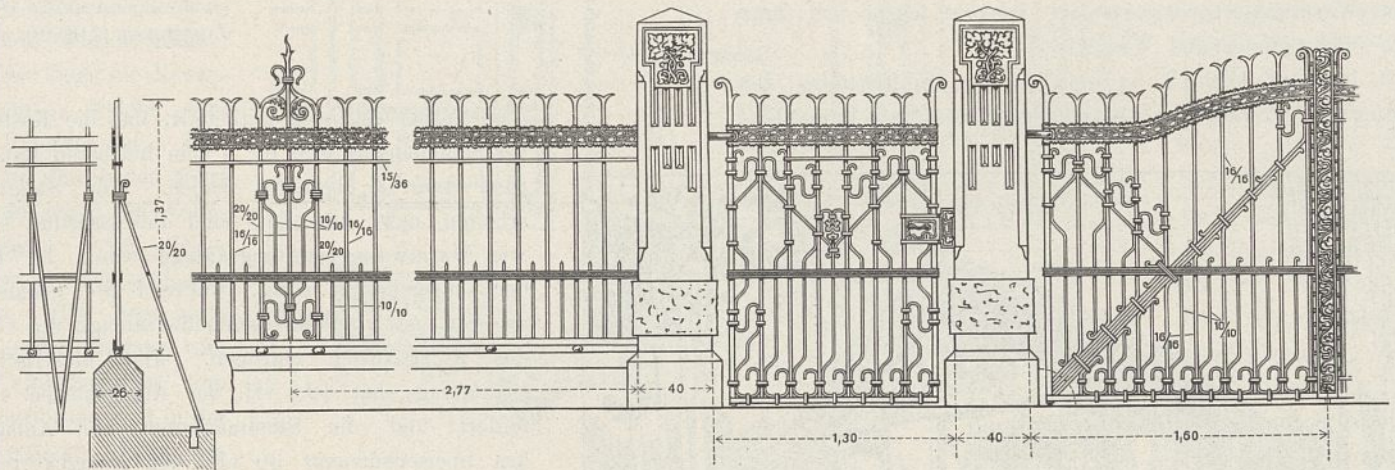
Gitter und Einfahrtstor an der Winklerstraße.
